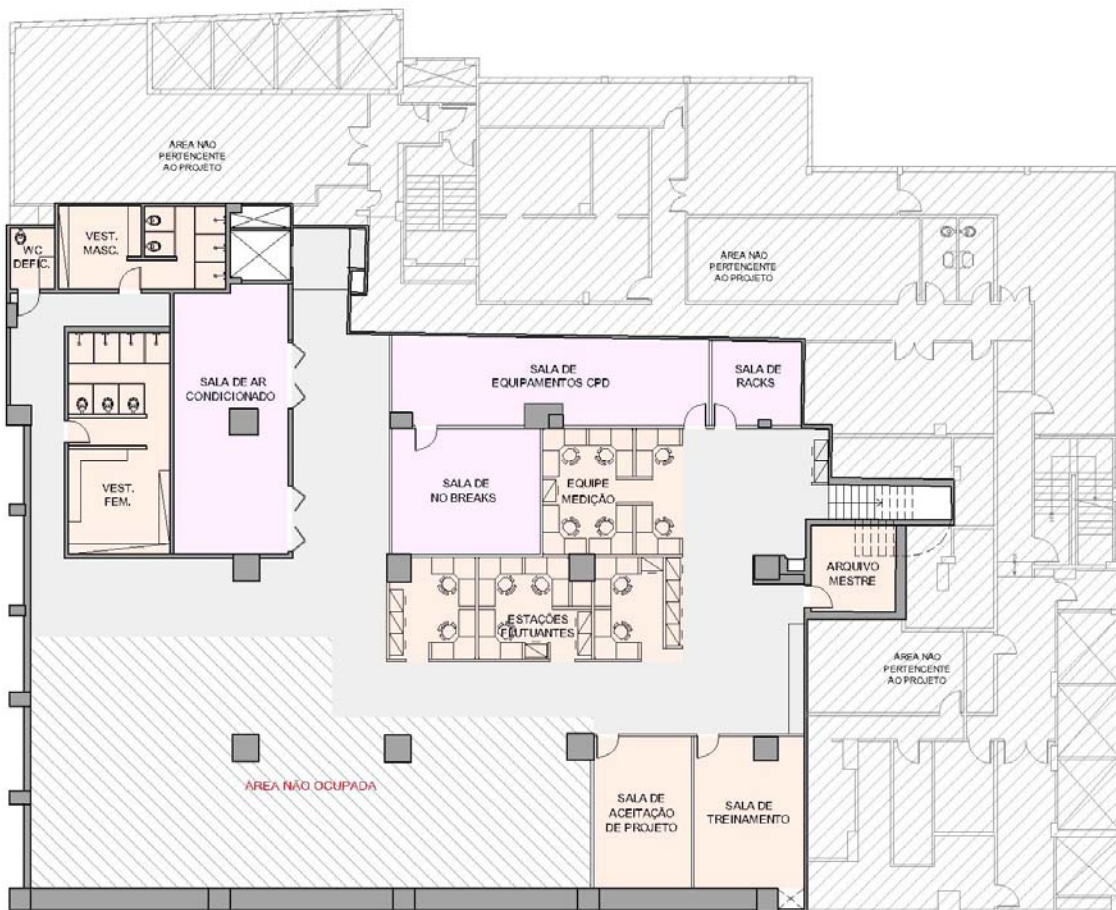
Planta baixa subsolo: primeiro estudo de layout (dois de junho)
